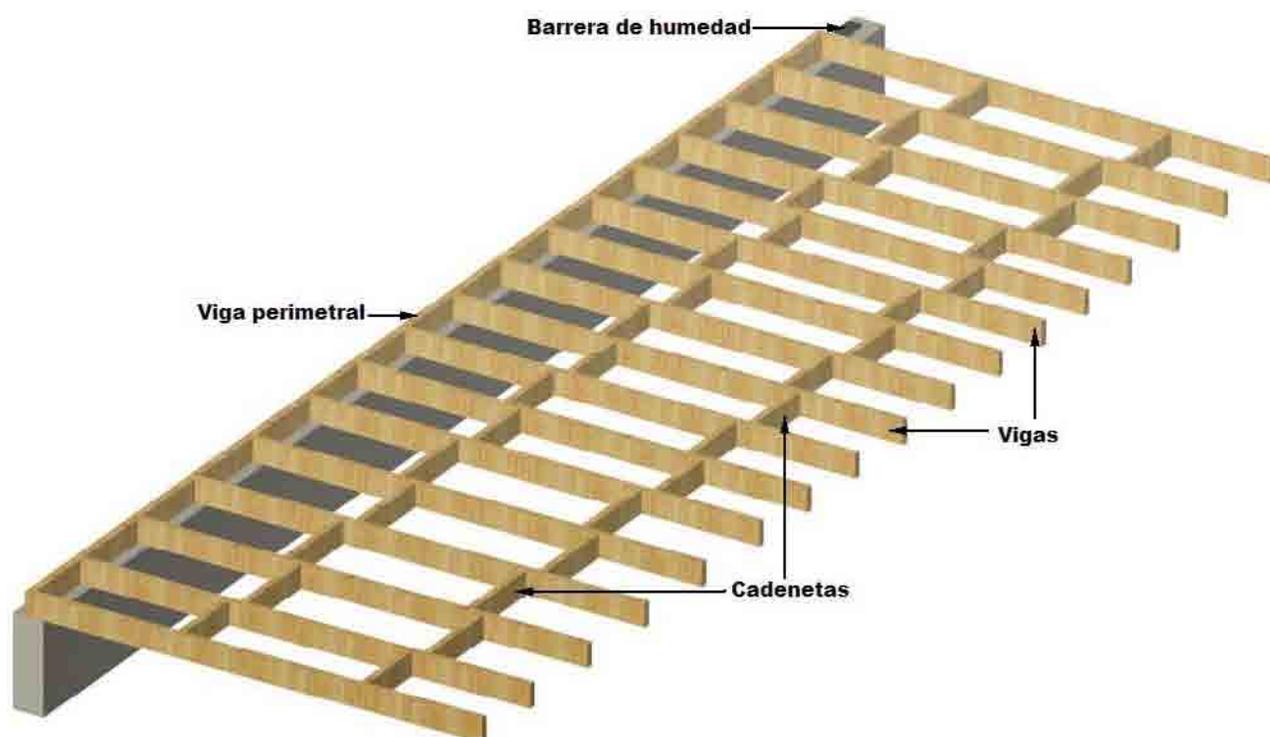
Ejemplo de un entramado horizontal sobre una fundación continua, conformado por un conjunto de vigas, dispuestas en forma paralela, y cadenas. Fuente: Elaboración propia.
